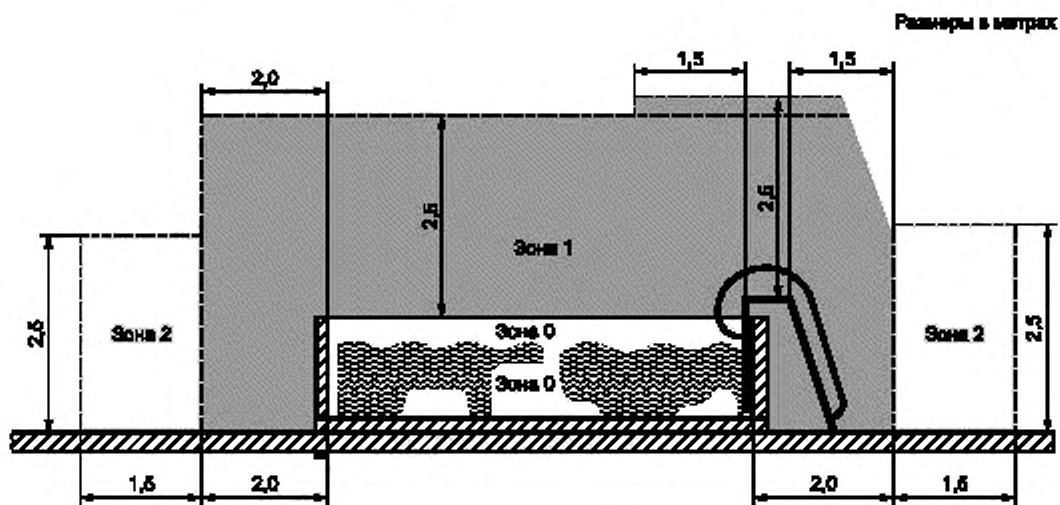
Размеры зон для плавательных бассейнов и лягушатников (вид сбоку)
